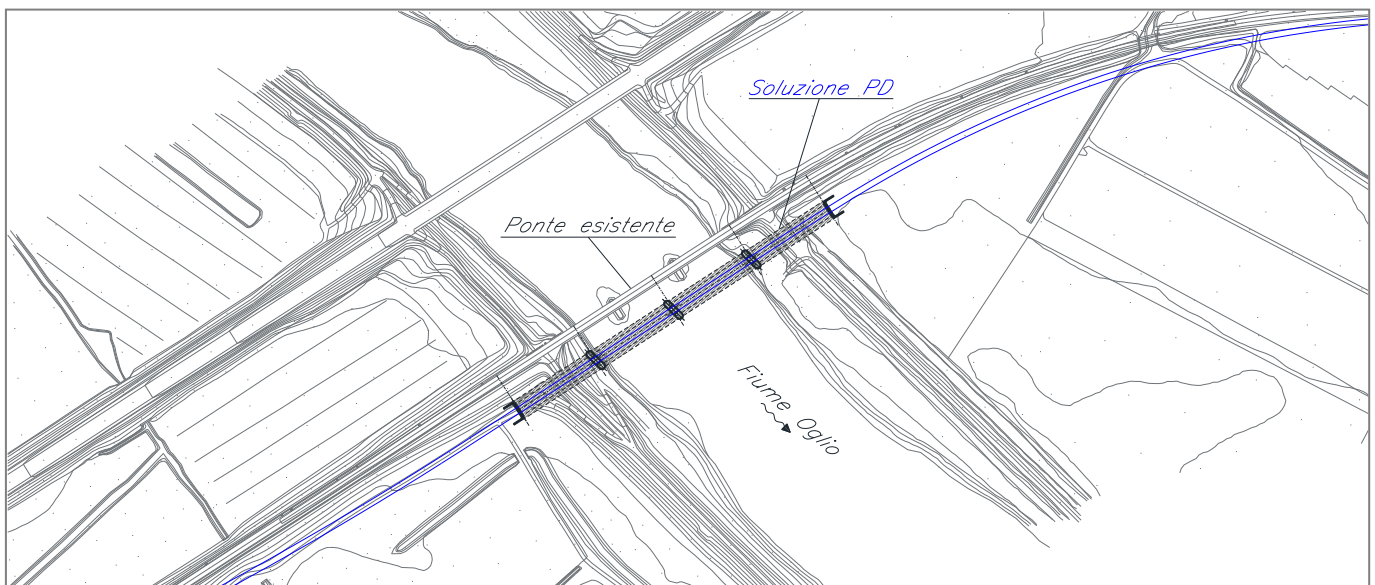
Stralcio planimetrico con ubicazione del Ponte esistente sul Fiume Oglio e dell'attraversamento in progetto (Soluzione PD) a valle dello stesso
